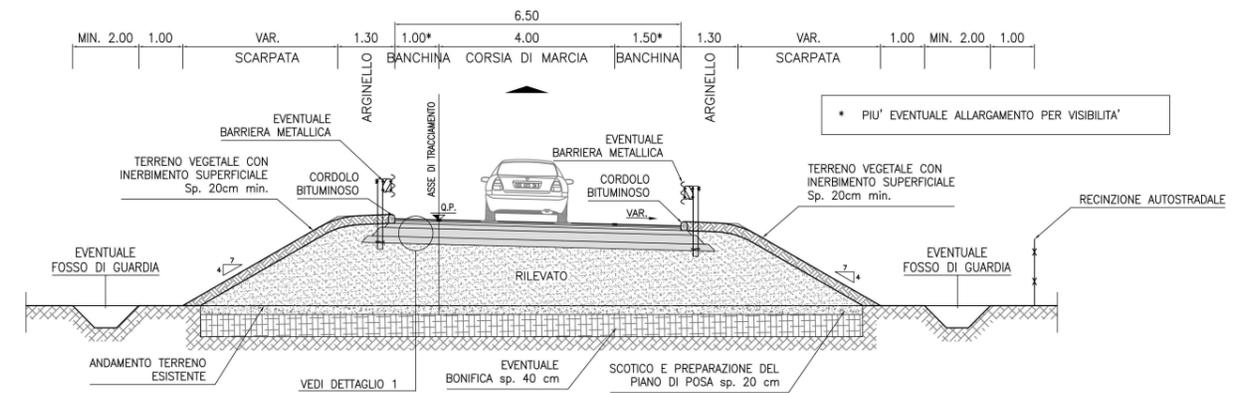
Sezione tipo – Rampa di svincolo monodirezionale
